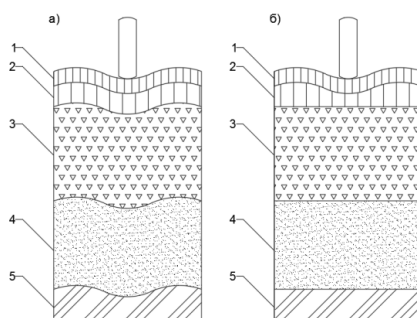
Виды колеобразования: а) пластическое, б) поверхностное (1 – верхний слой покрытия, 2 – нижний слой покрытия, 3 – основание, 4 – дополнительный слой основания, 5 – грунт)
